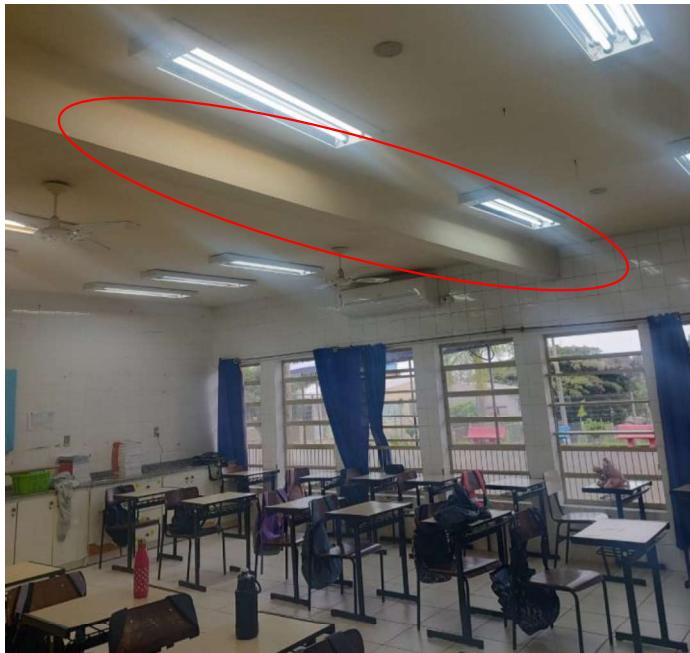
Sala de aula térreo / viga de apoio da laje de piso da biblioteca.
